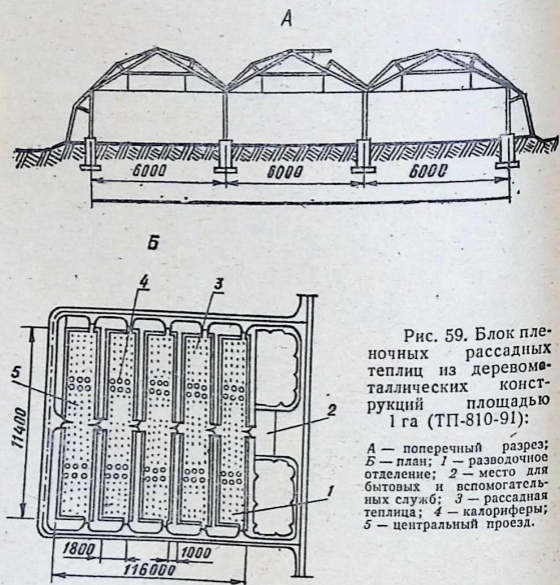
Блок пленочных рассадных теплиц из дерево-металлических конструкций площадью 1 га (ТП-810-91):
